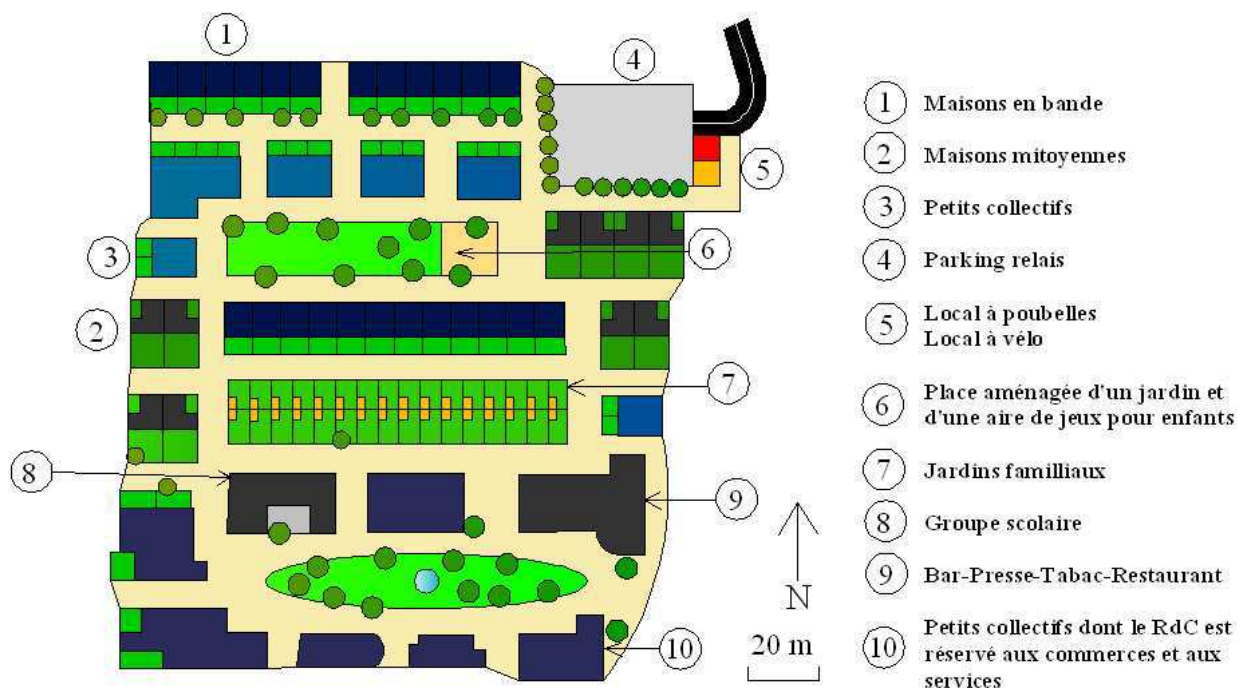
Illustration de pistes à suivre pour le plan de l'Eco-quartier
